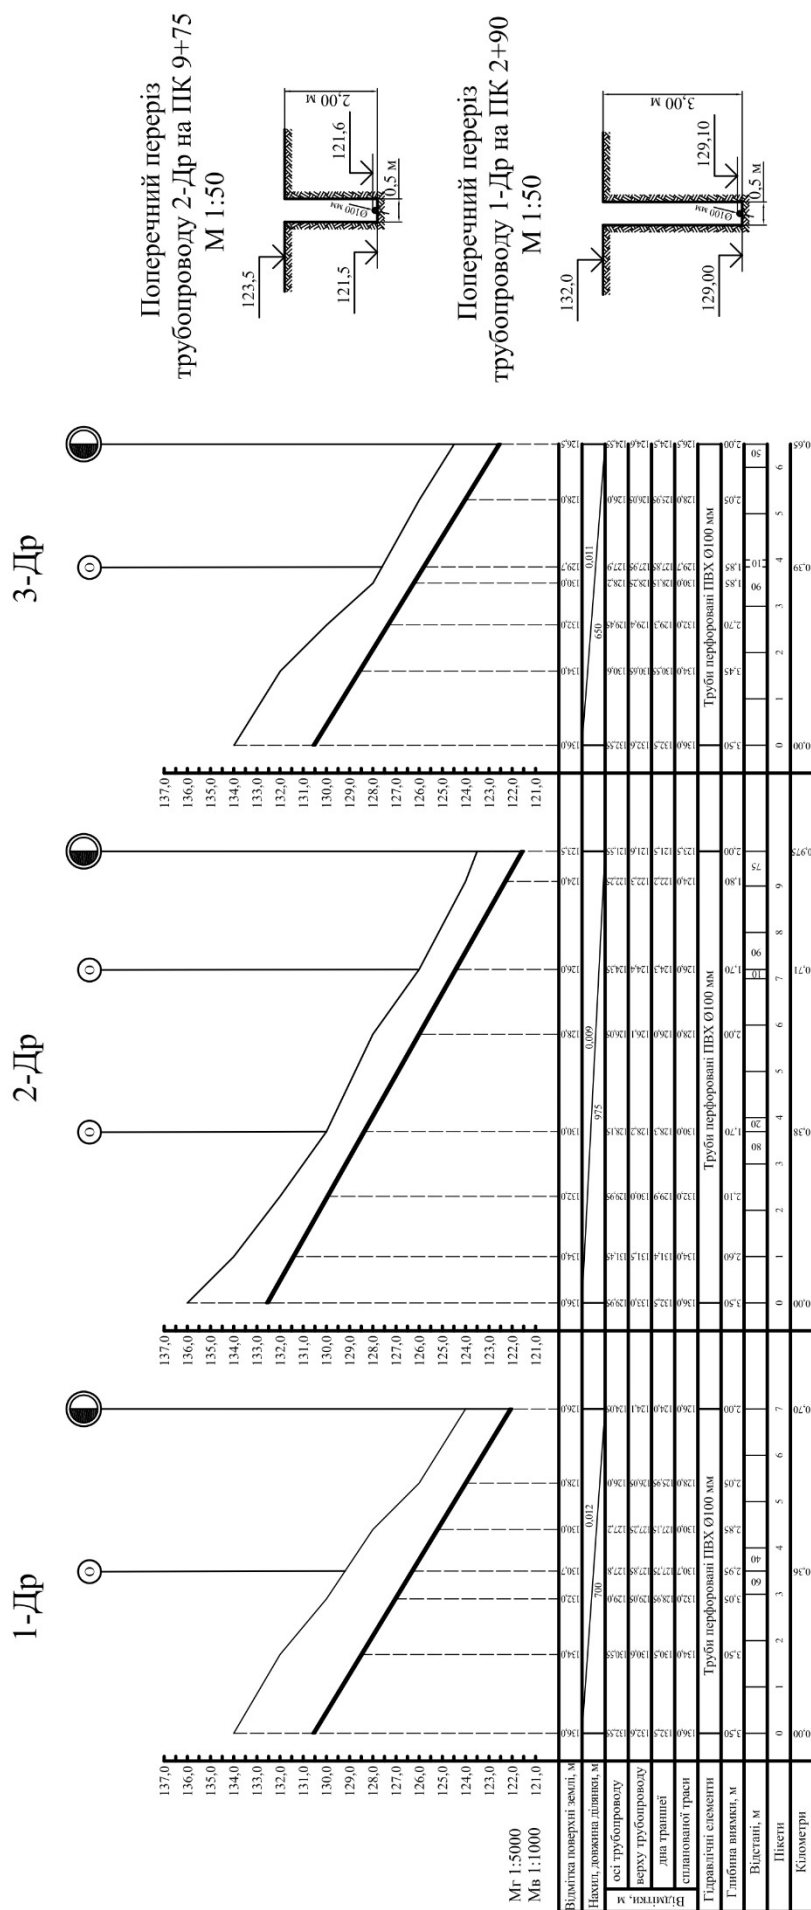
Поздовжній профіль та поперечні перерізи дренажного трубопроводу
